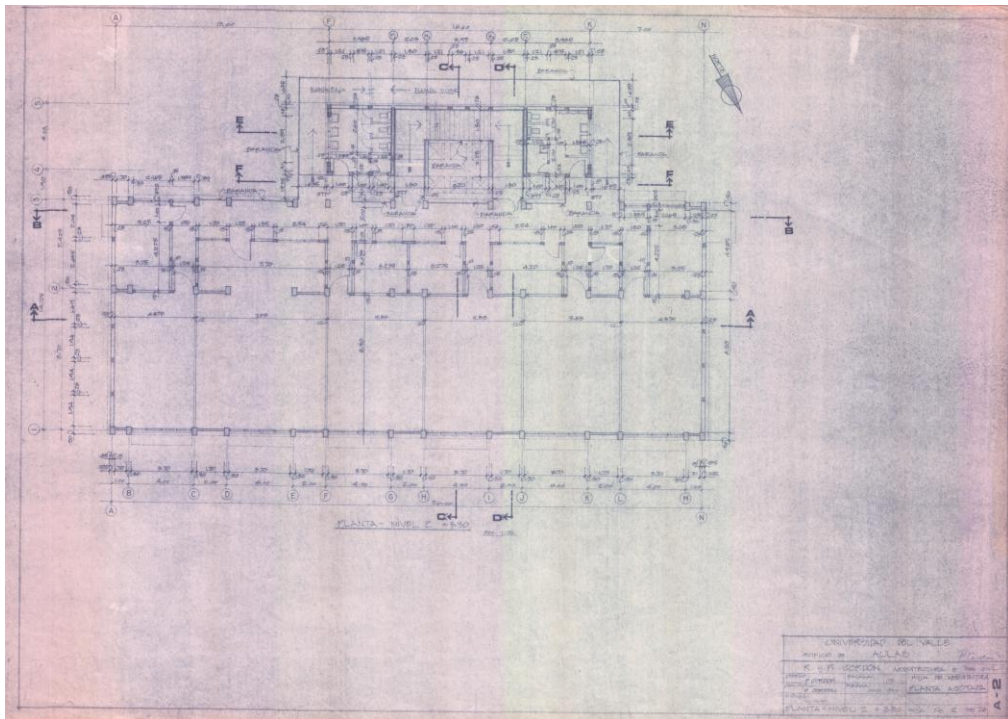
Plano de planta nivel 2 Edificio A en Universidad del Valle de Guatemala Campus Central. Por R. y P. Córdón Arquitectura e Ing. Civil (1983)
